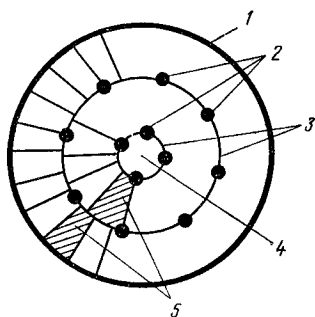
Схема сборного покрытия цилиндрического резервуара
